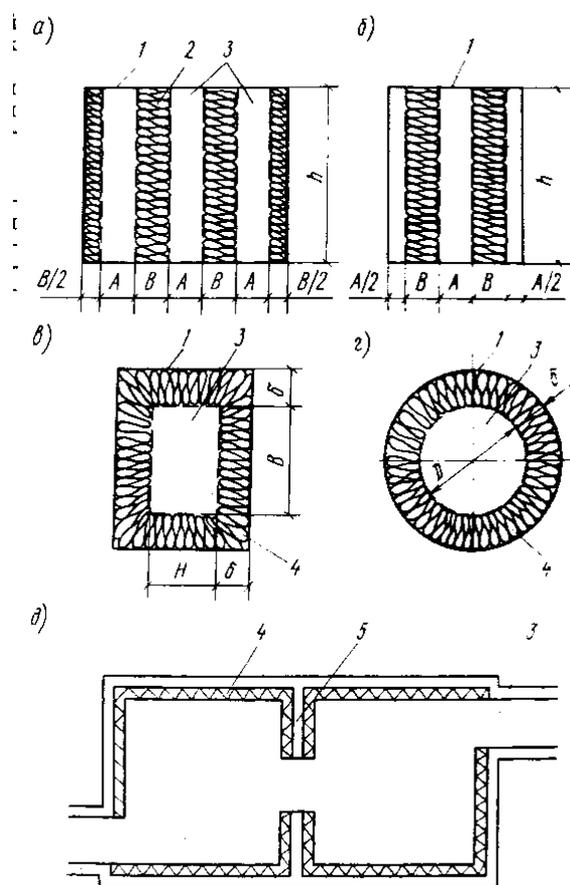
Схемы конструкций глушителей для вентиляционных установок
